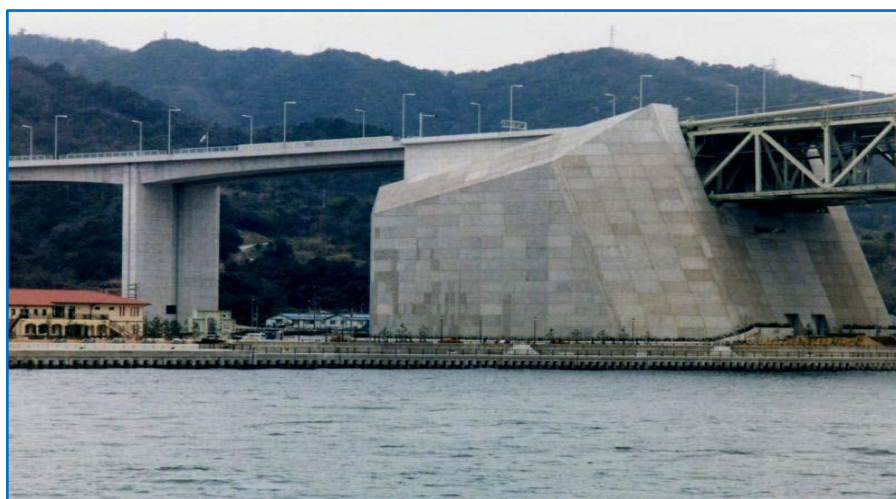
Vista de uno de los anclajes del puente colgante Akashi-Kaikyo en Kobe, Japón construido con hormigón autocompactante.
